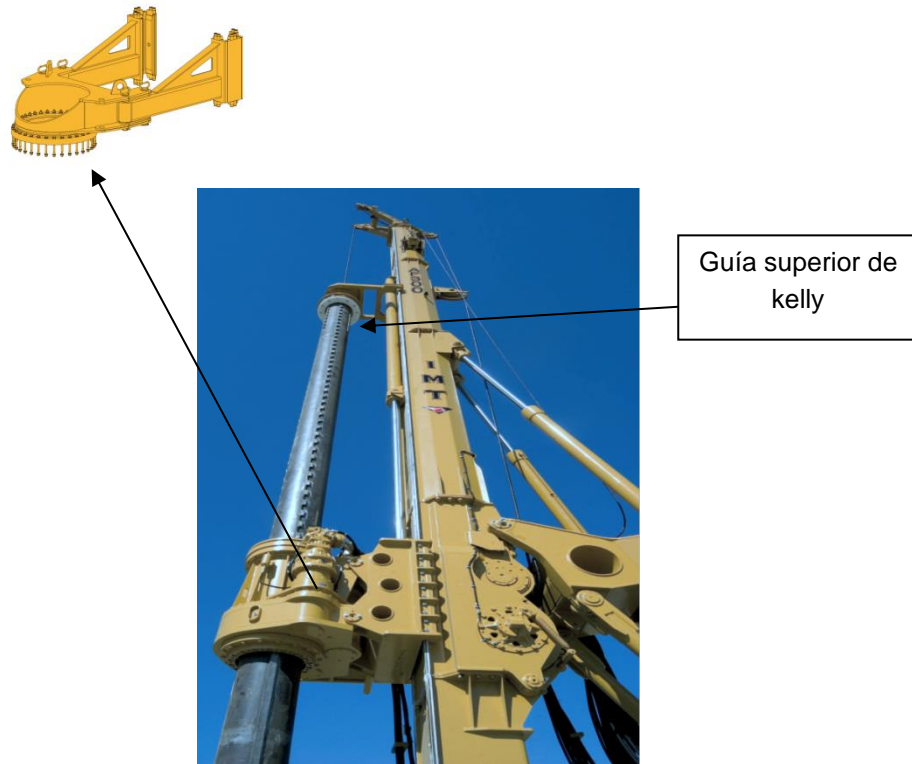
Vista en alzado del Kelly en la Pilotera
